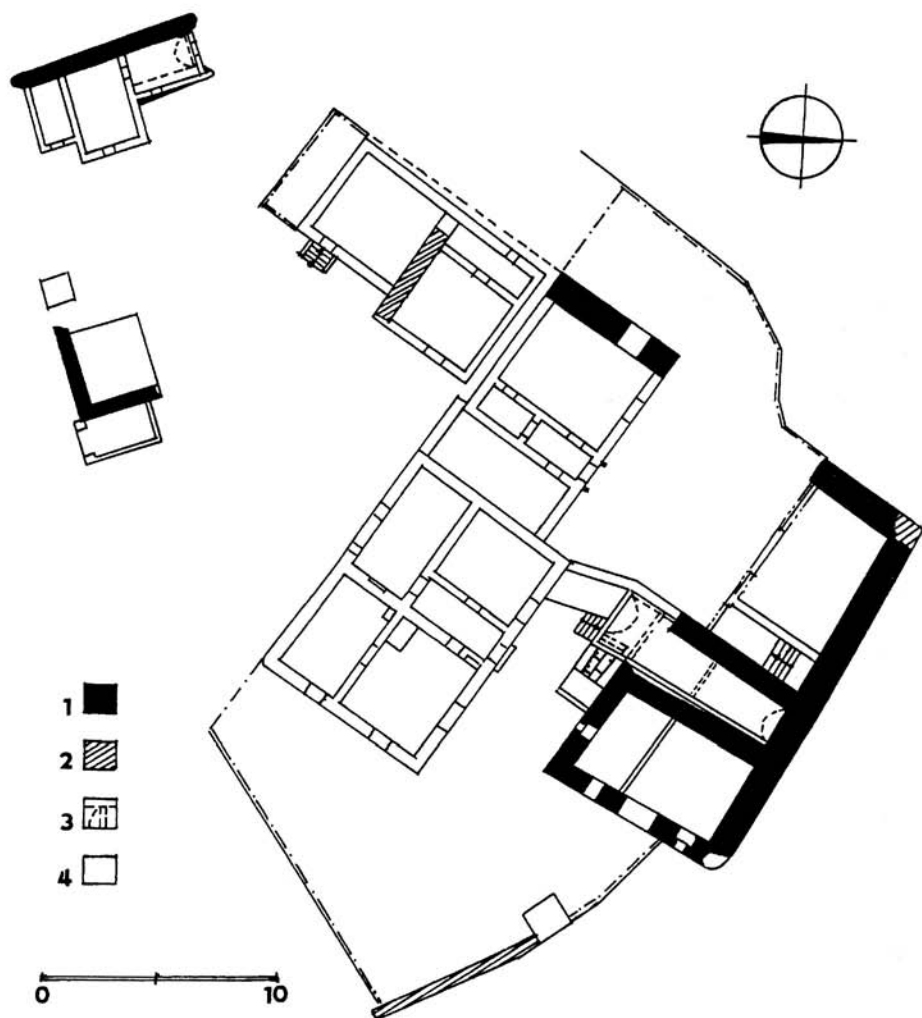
Květnice. Grundriss der Burg nach J. Pešta. 1 – mittelalterliches Mauerwerk, 2 – wahrscheinlich mittelalterliches Mauerwerk, 3 – Kellerraum, 4 – neuzeitliches Mauerwerk. Zeichnung: V. Durdik.
